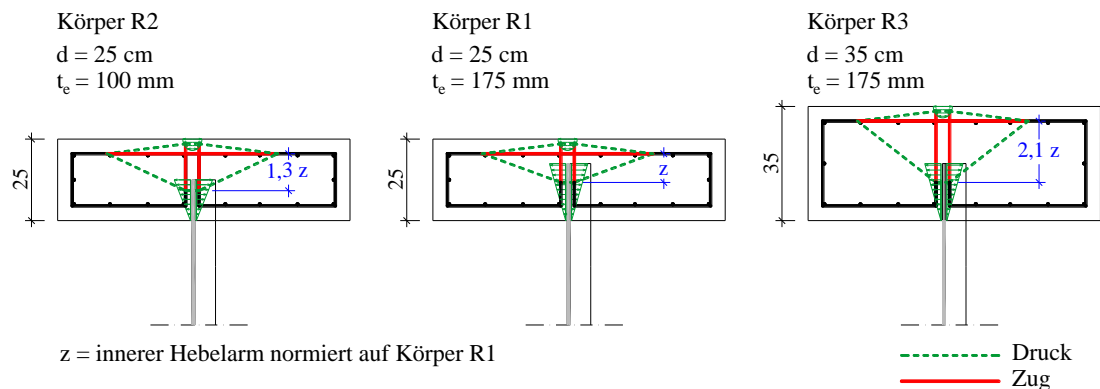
Ebenes Stabwerkmodell – horizontal - zum Tragverhalten im Betongurt
